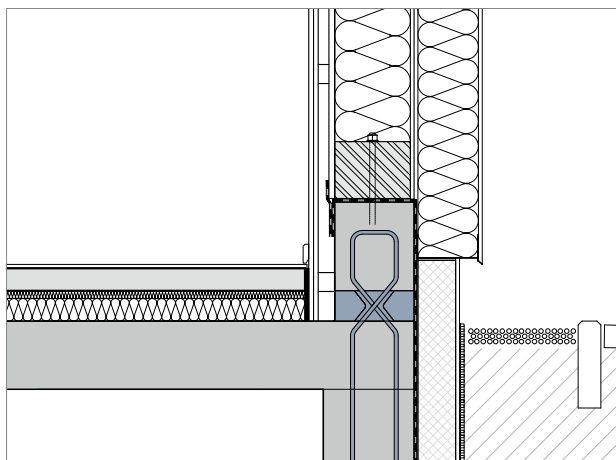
Schématické znázornění prvku Schöck Sconnex® typ W u sendvičových stěn a nadstropní tepelné izolace
